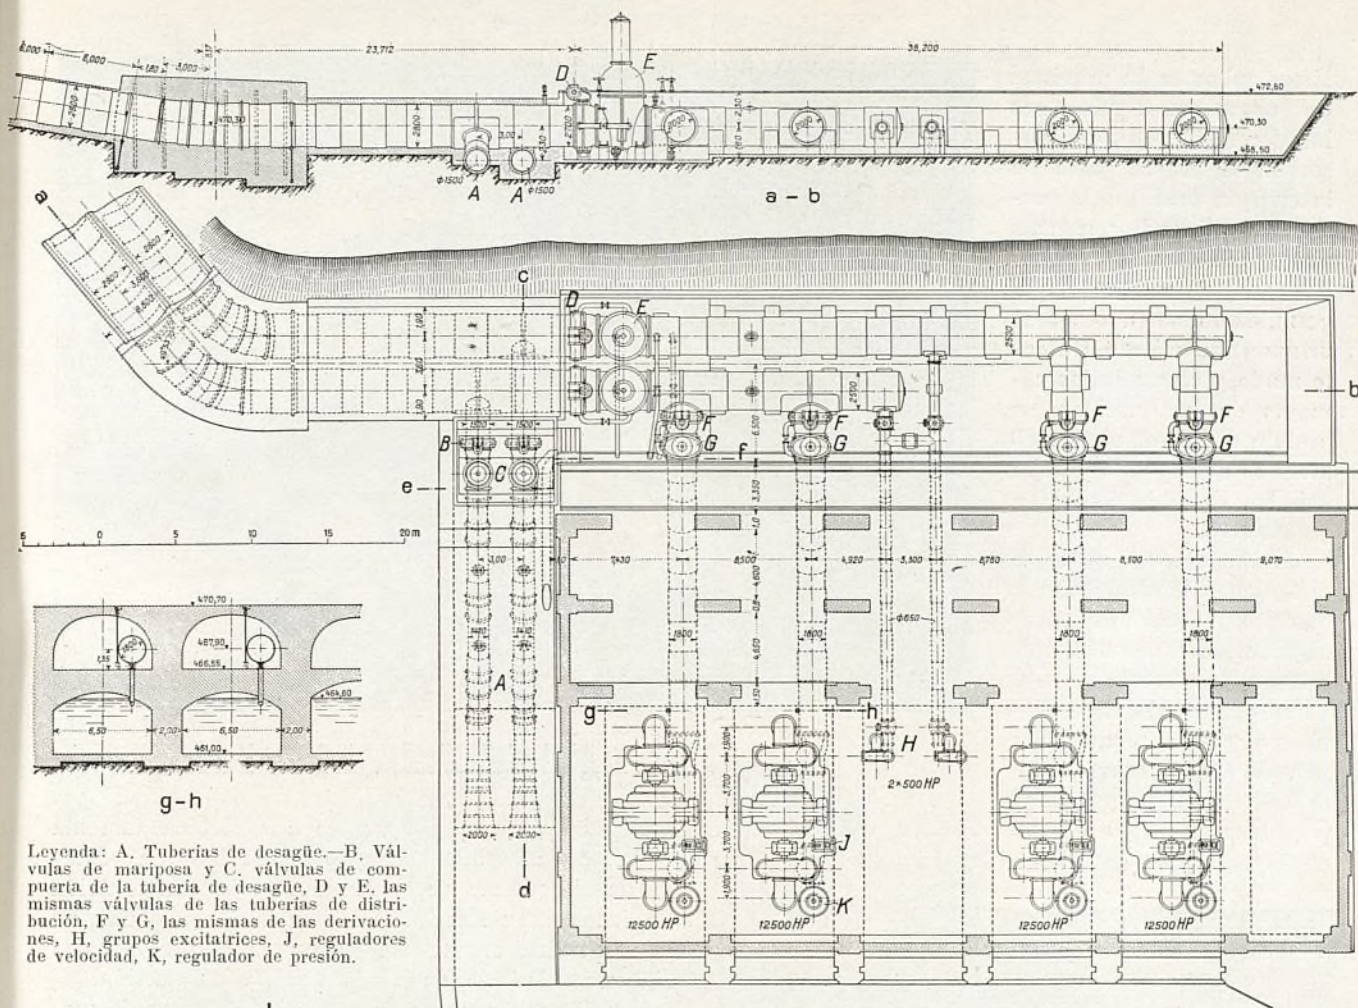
Tubería de distribución y de desagüe, y planta de la casa de máquinas; cortes a-b y g-h.—Escala 1 : 500.
